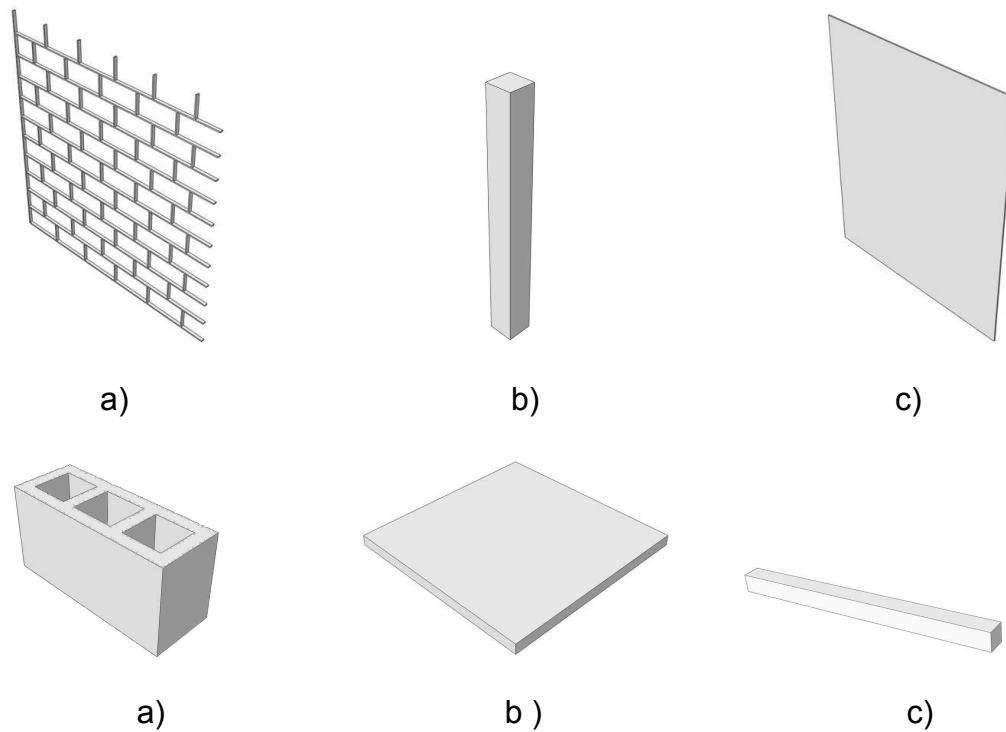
Estructura en estudio a) juntas de mortero, b) columna de concreto, c) acabado de mortero/yeso, d) bloque hueco de concreto, e) losa de concreto, f) viga de concreto
